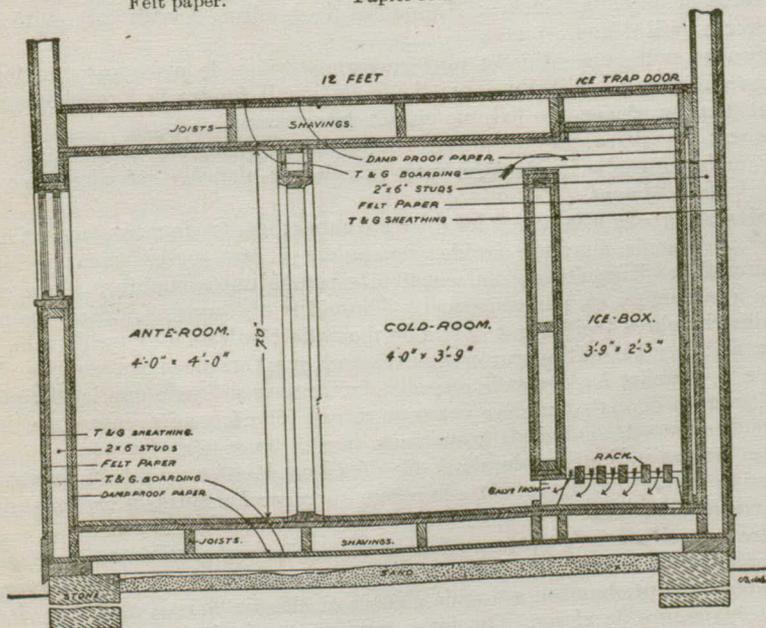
COUPE DU RÉFRIGÉRATEUR.
